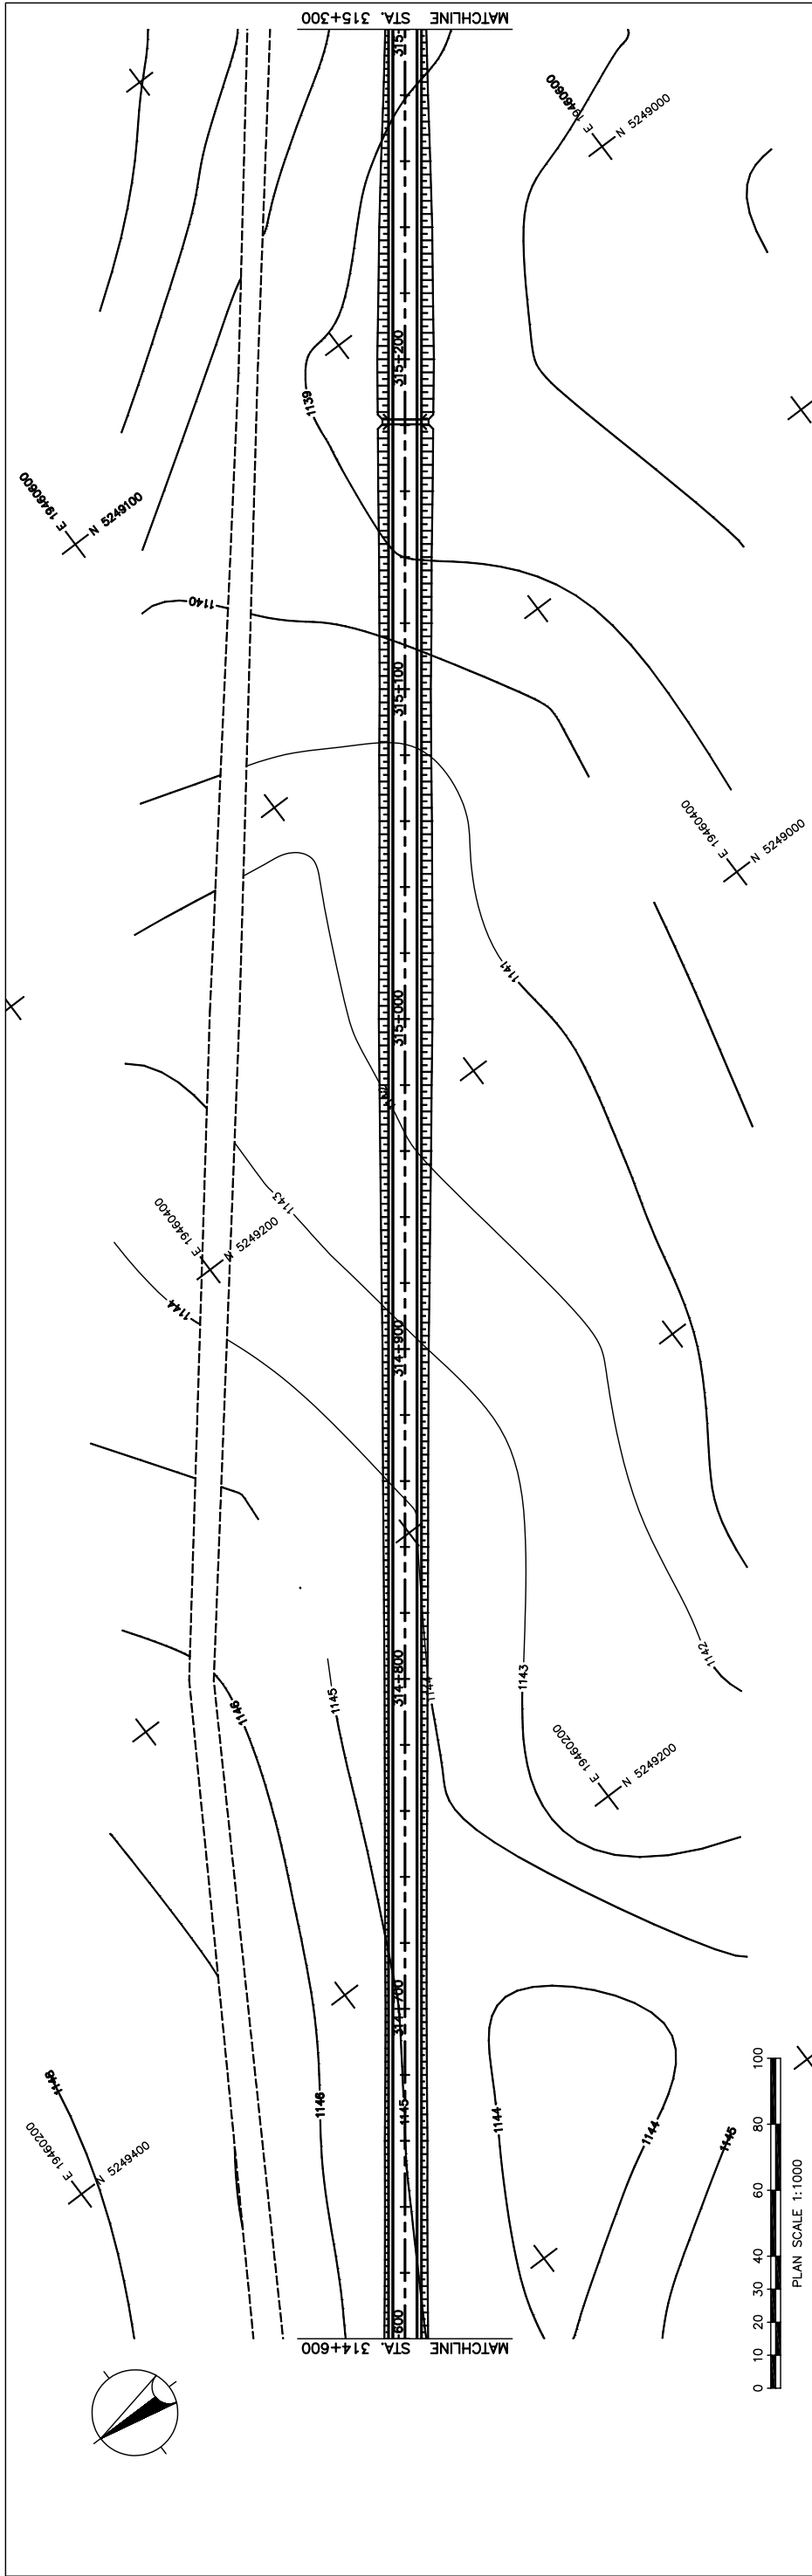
全体平面・縦断面 (Section VI Sta.313+200-Sta.313+900)
